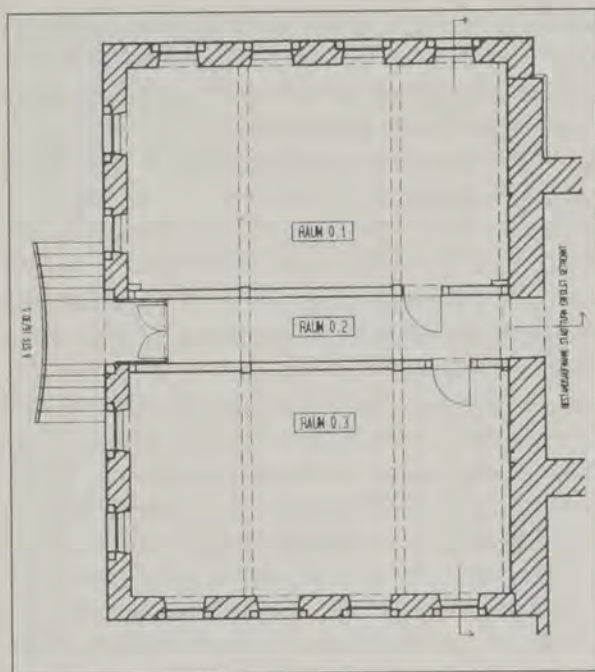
Backnang, Turmschulhaus. Grundriß, Erdgeschoß.
